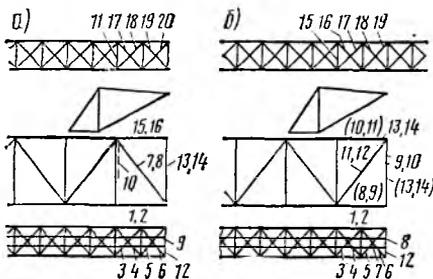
Последовательность (1—20) установки элементов панели краном
